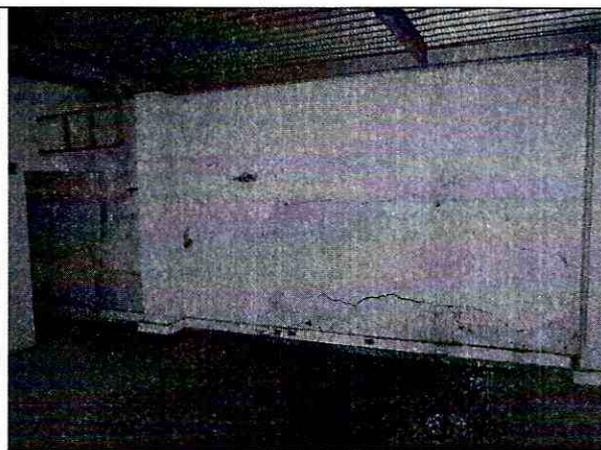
Agrietamientos y fracturas de muro, primer piso.
